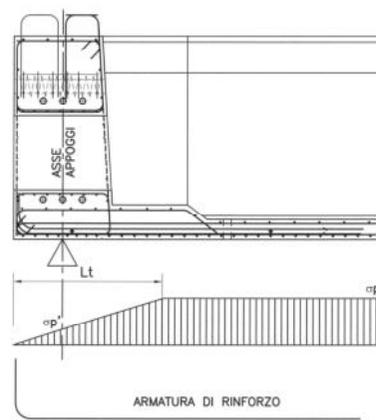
Lunghezza di trasferimento della precompressione ed armatura di rinforzo
